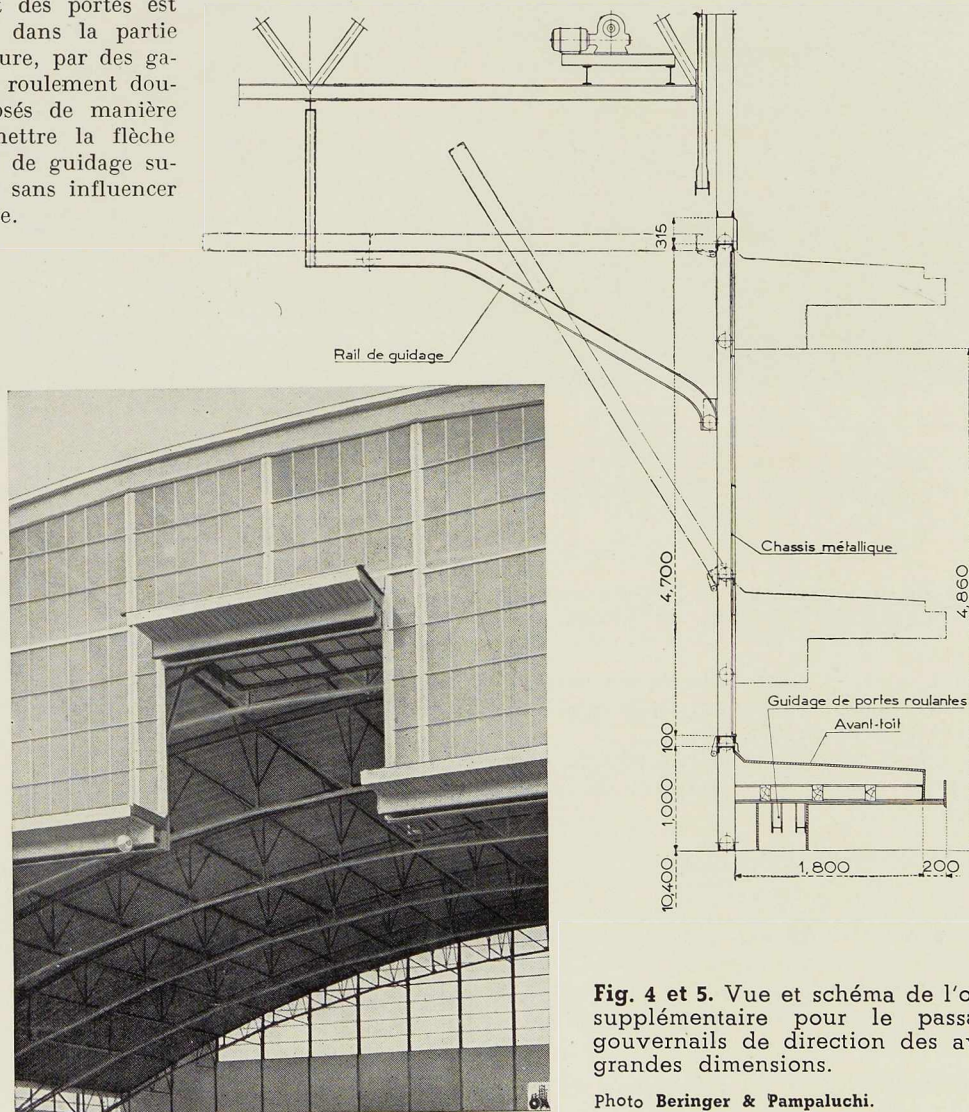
et 5. Vue et schéma de l'ouverture supplémentaire pour le passage des gouvernails de direction des avions de grandes dimensions.
